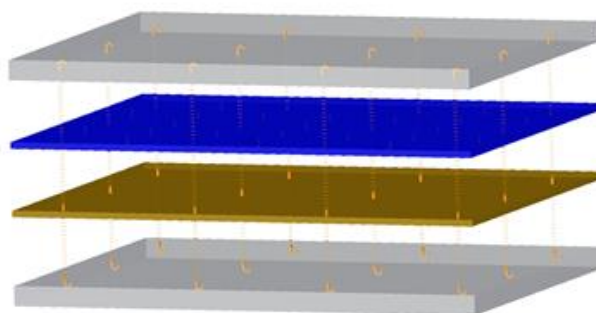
Esquemas de ligação dos materiais constituintes dos painéis pré-fabricados em 3D
